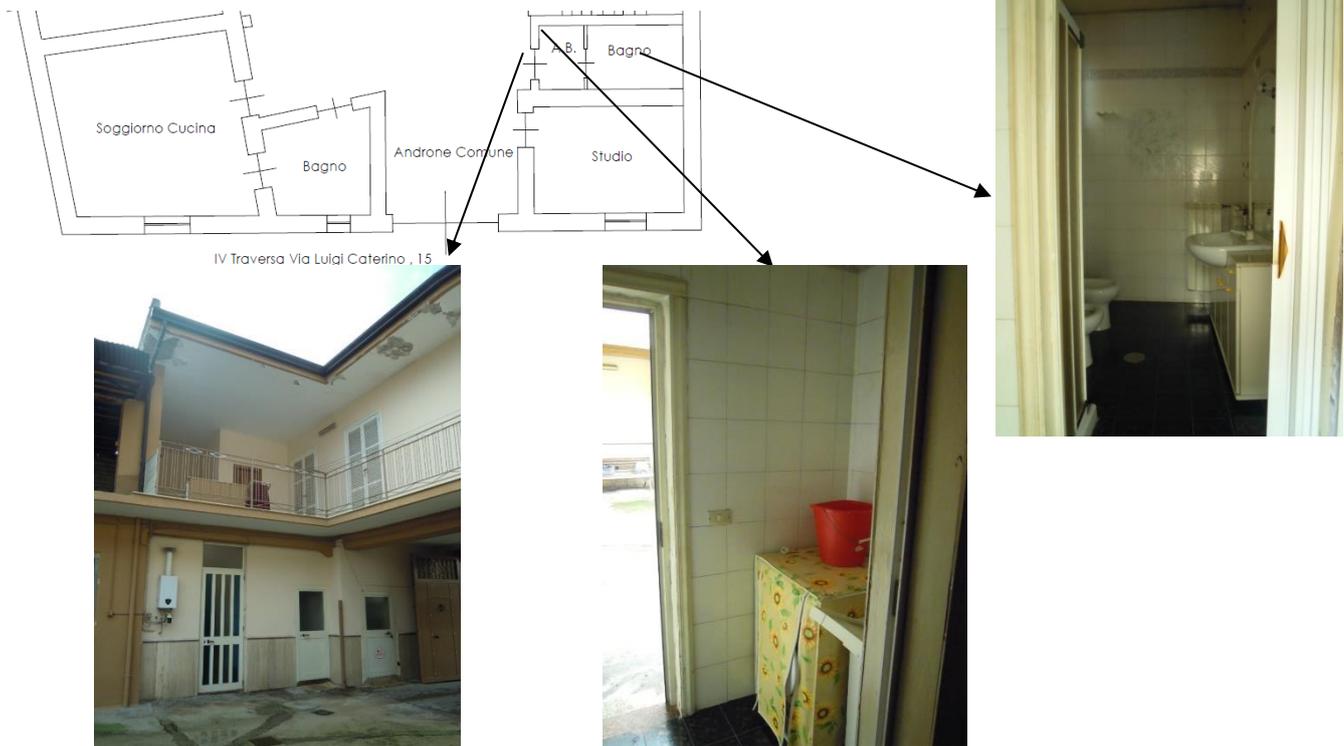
Individuazione fotografica del bagno del bene oggetto di pignoramento.
